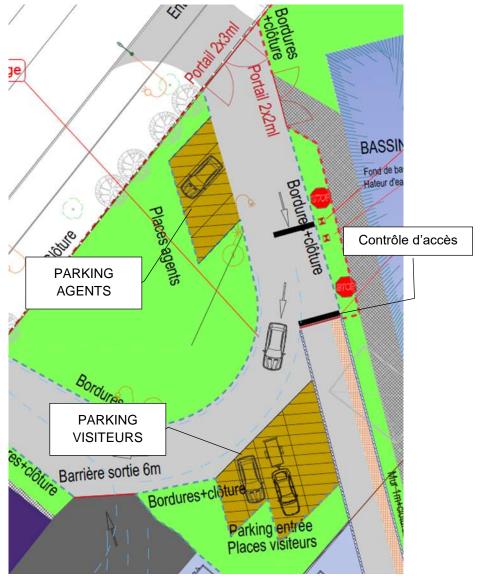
Localisation places de parking visiteurs et agents- Extrait du plan masse AVP
